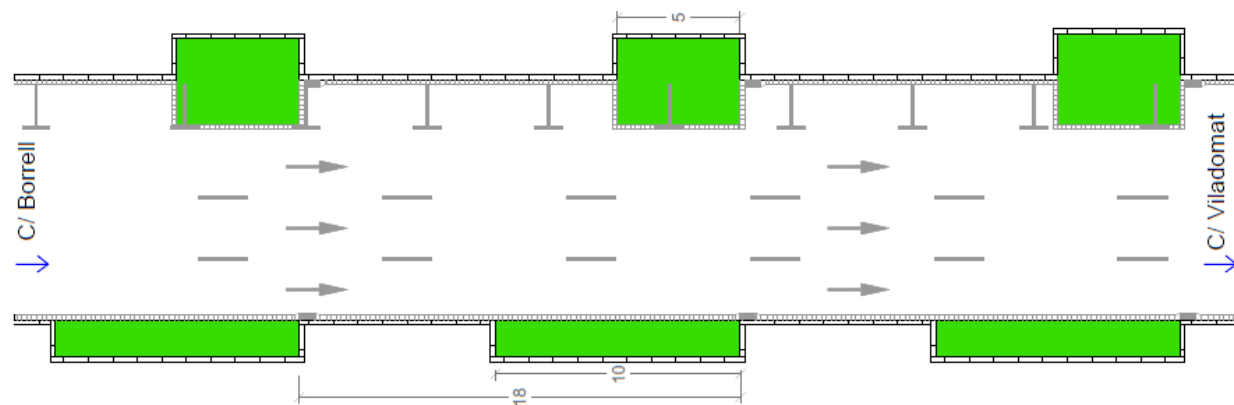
Planta de la propuesta para la C/ Mallorca, caso b) (Tipo 2).
